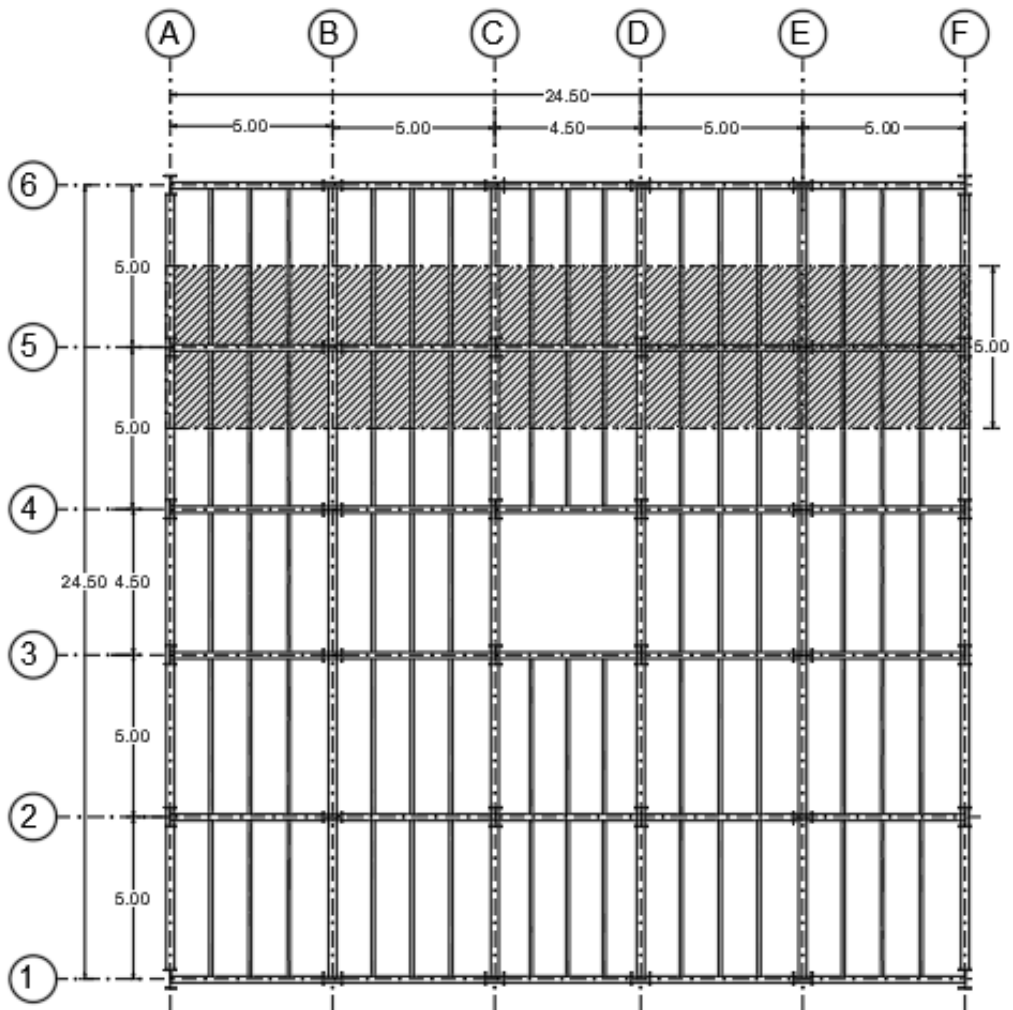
Esquema de pórtico a ser analizado en planta – Edificio 11 pisos
